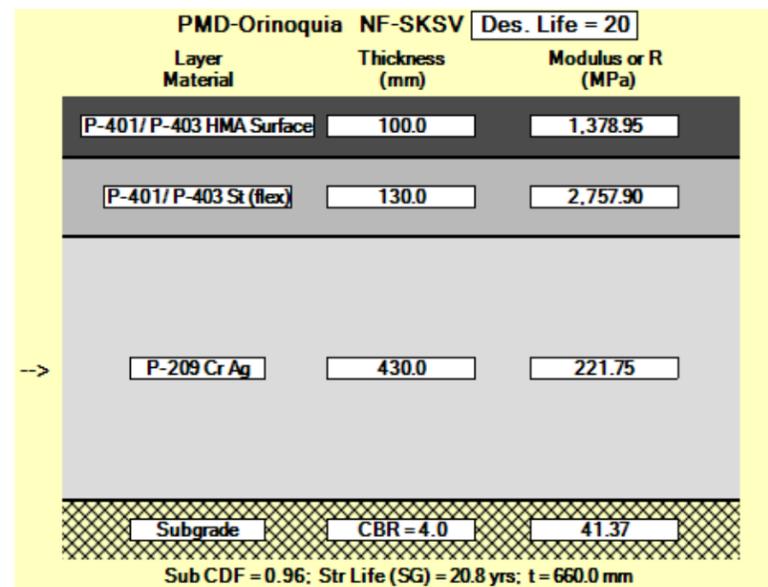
Estructura del pavimento de la pista de vuelos PCN 32
